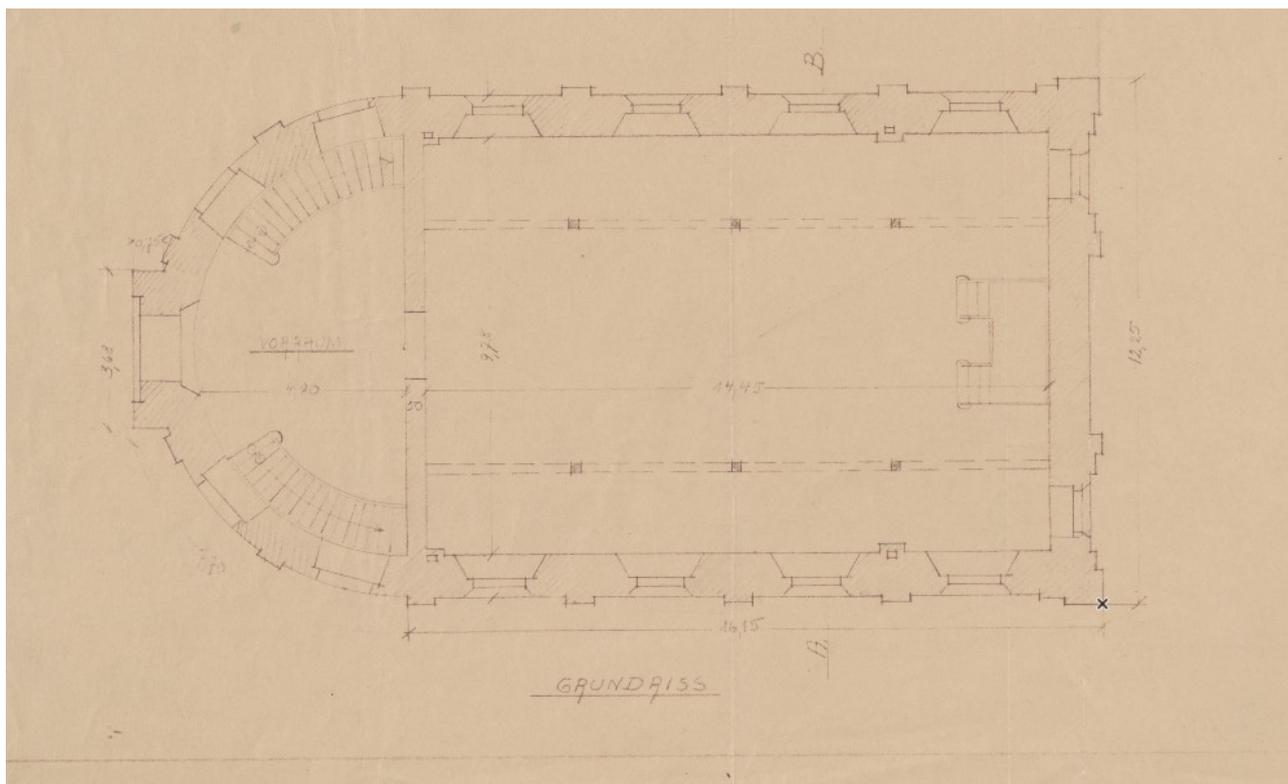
Herder_Institut_Grundriss_Zagan
